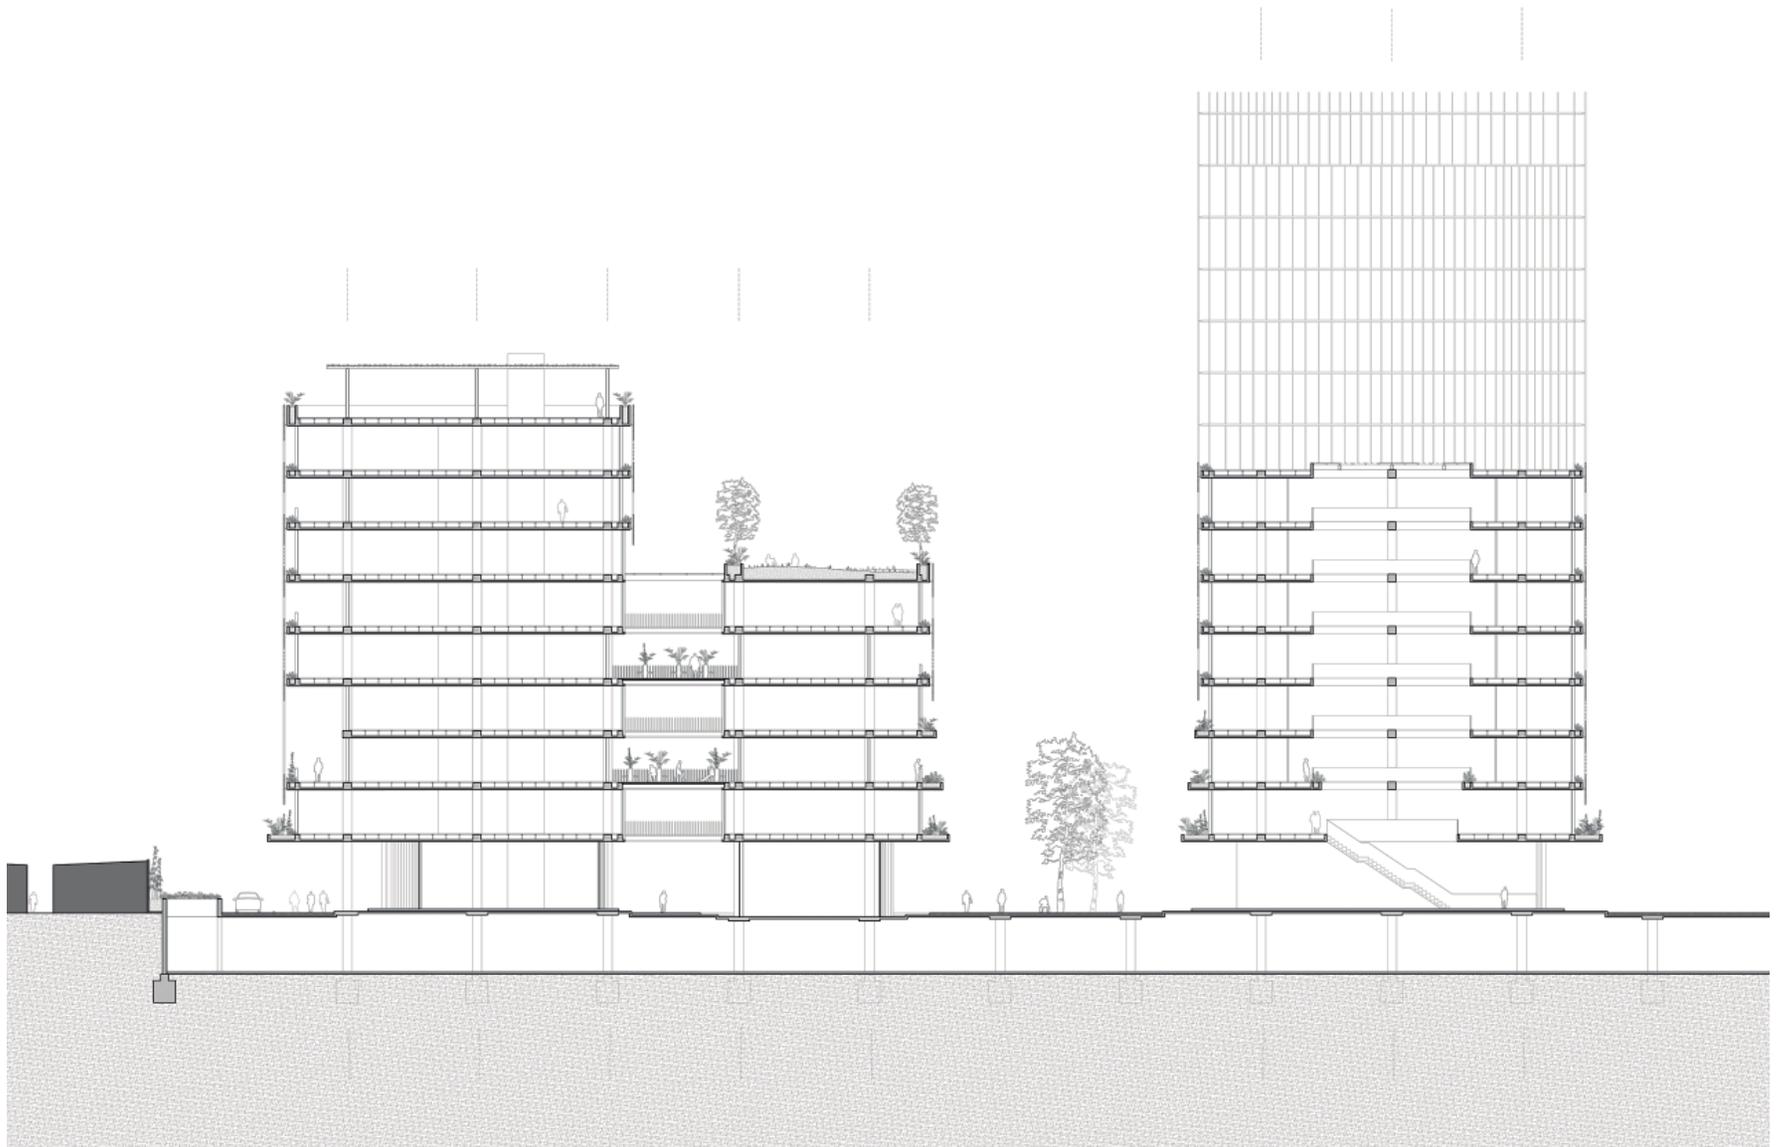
Corte B-B'. (Vista hacia el norte). Fuente: Elaboración Propia.
